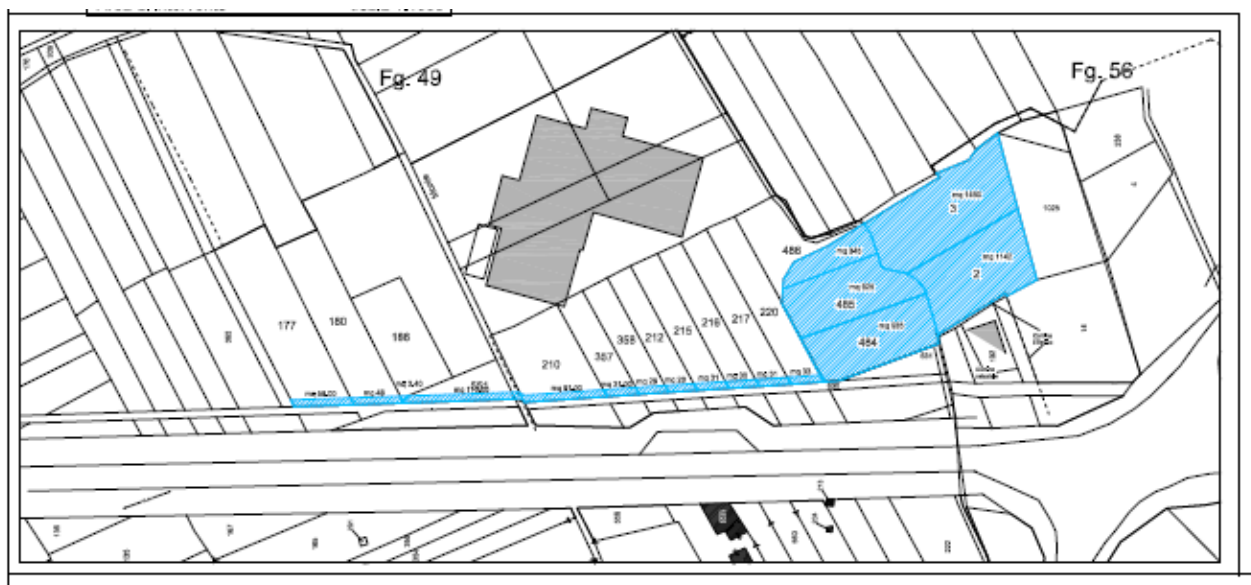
Planimetria di progetto (TAV.1) di cui alla Concessione Rep. N.4159/2005
